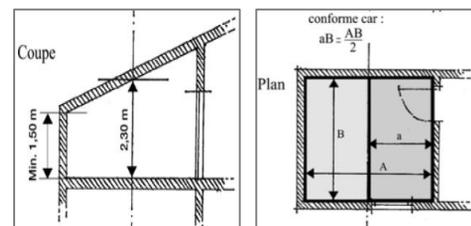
Hauteur minimale sous plafond des locaux habitables dans les combles
